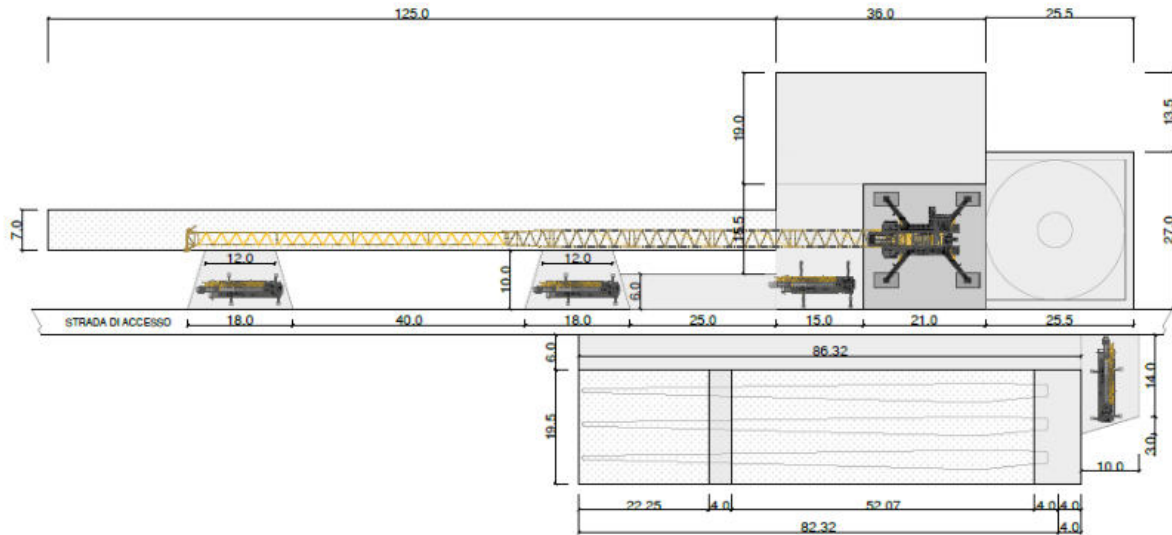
Planimetria piazzola (configurazione completa) in fase di cantiere
